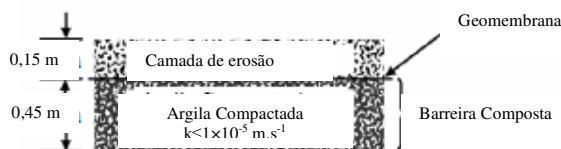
Camada de erosão e de infiltração (Adaptado de EPA, 2003).
